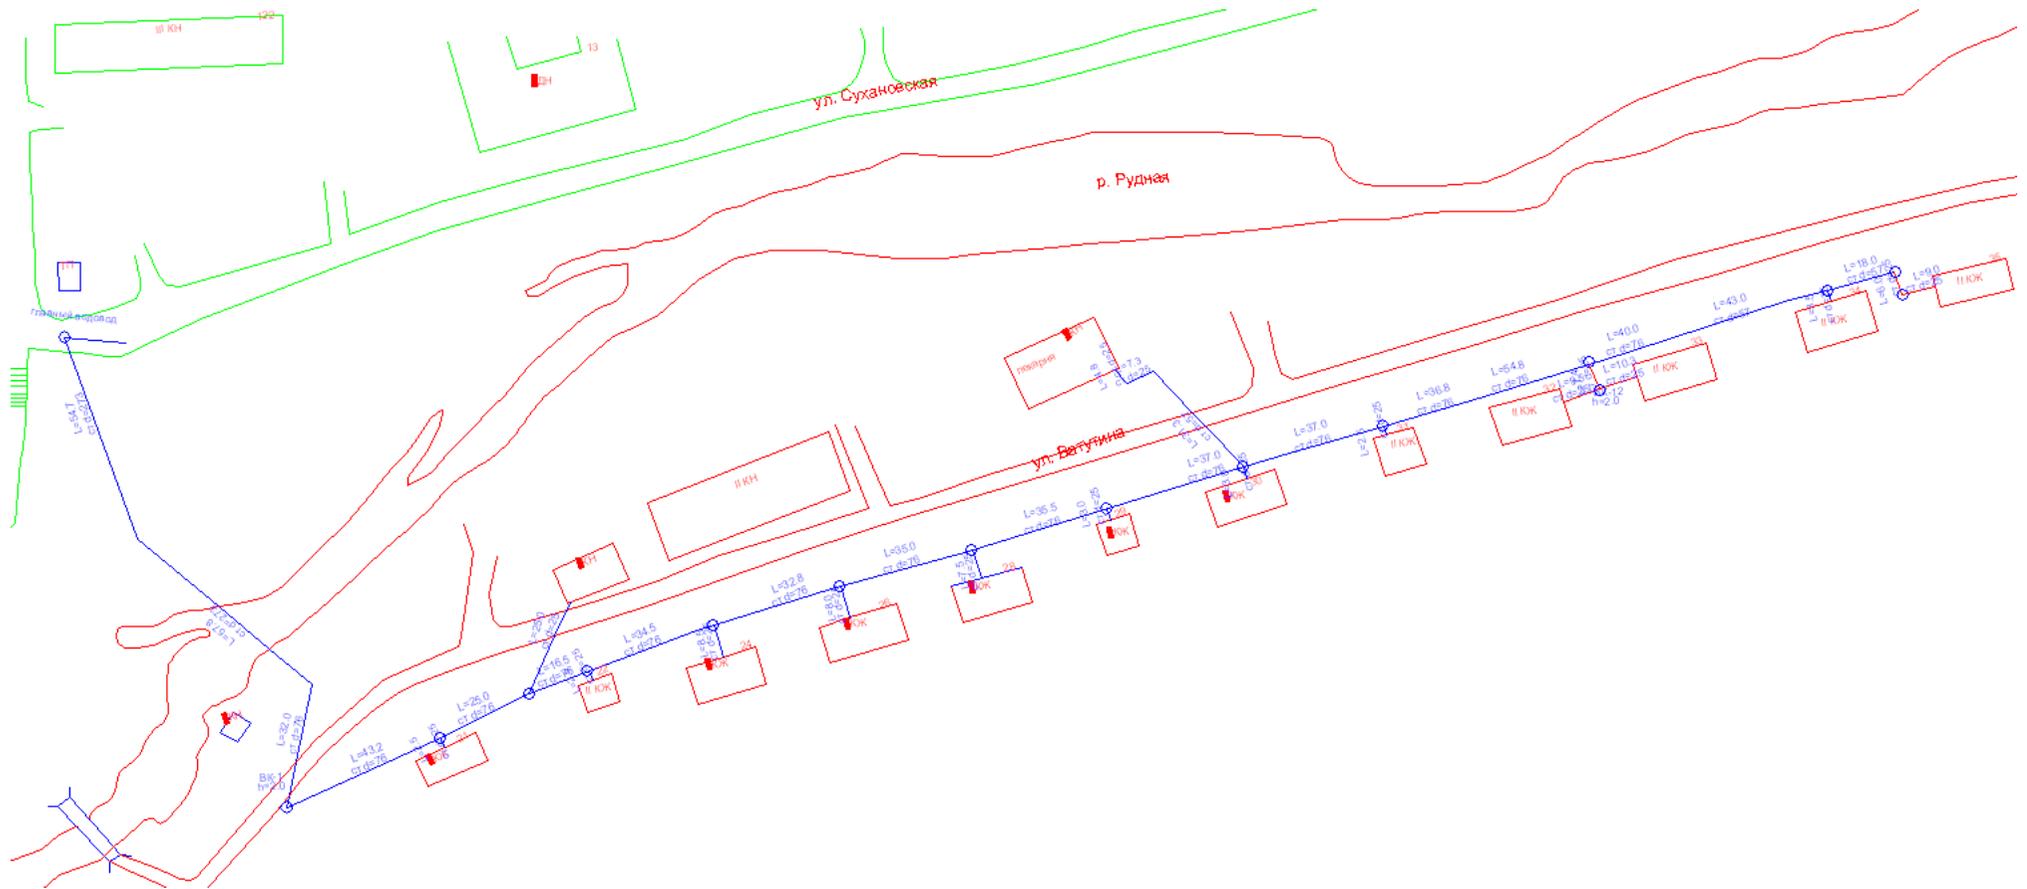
План водопроводной сети от дома № 11 по ул. Сухановской до дома № 21 – 35 по ул. Ватутина г. Дальнегорск
